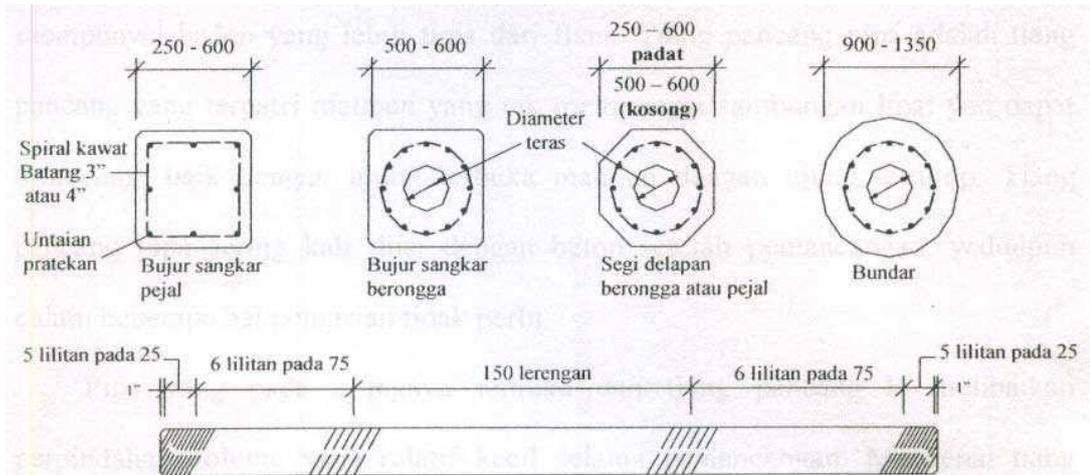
Tiang pancang beton *precast concrete pile
